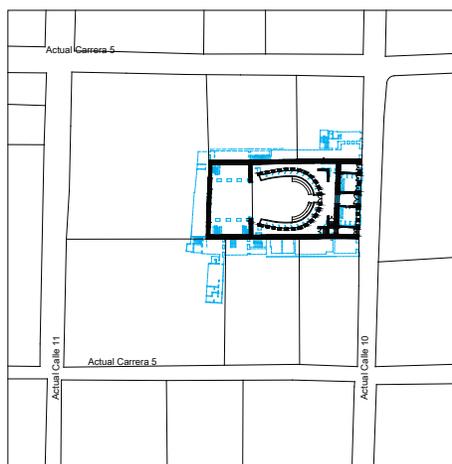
Montaje de la hipótesis propuesta para el plano del antiguo Coliseo Ramírez y el plano del actual Teatro Colón.
